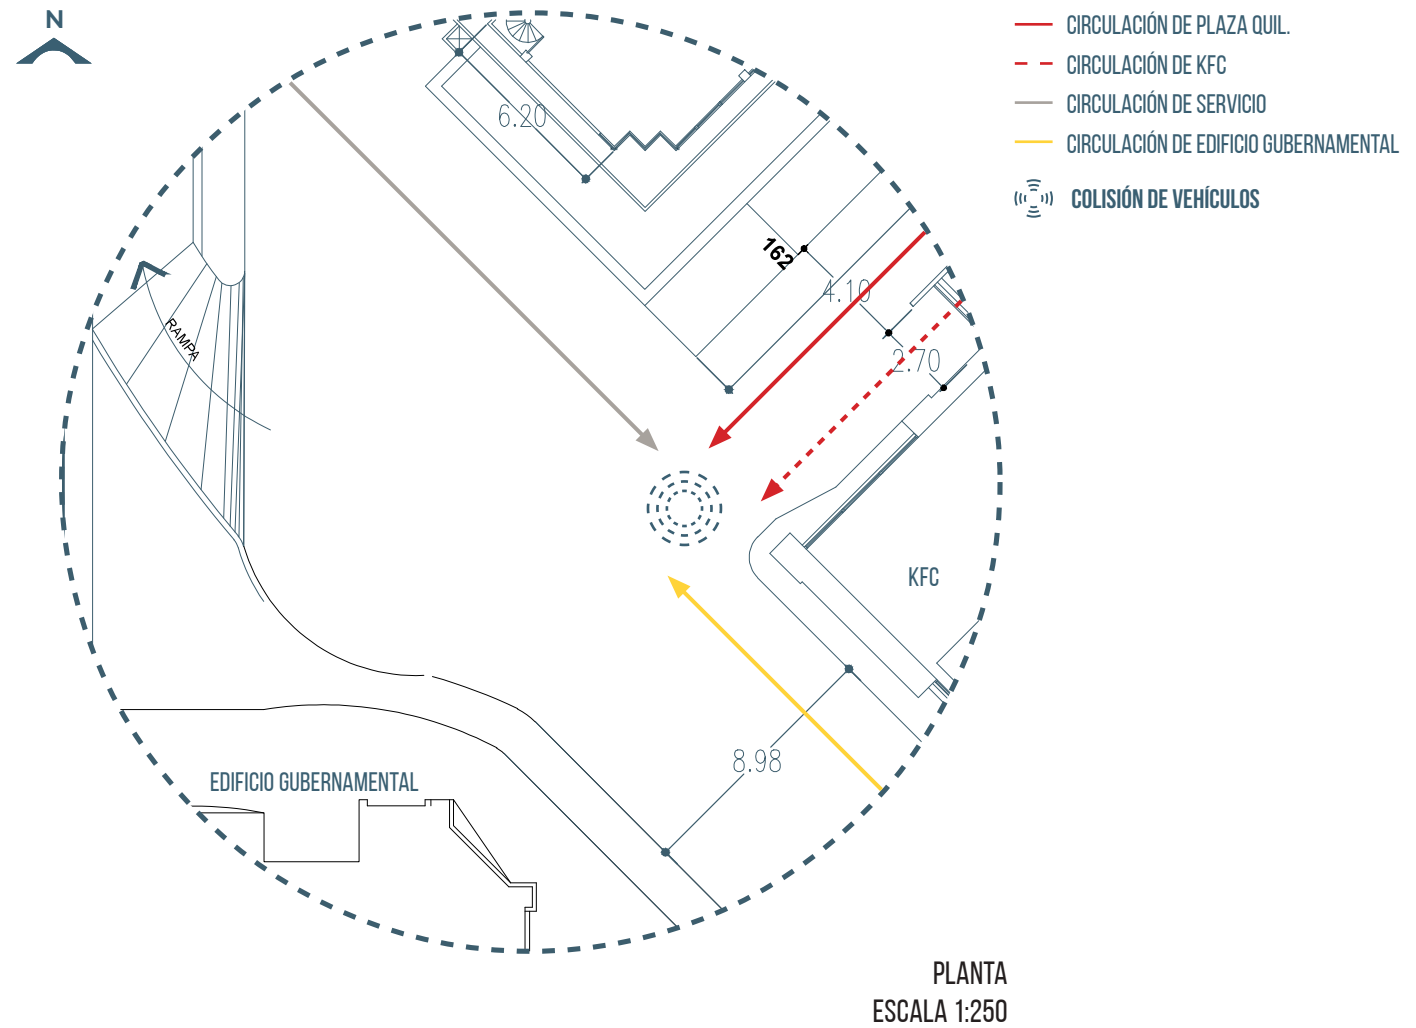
Planta de problema de circulación vehicular en la parte posterior de KFC.
